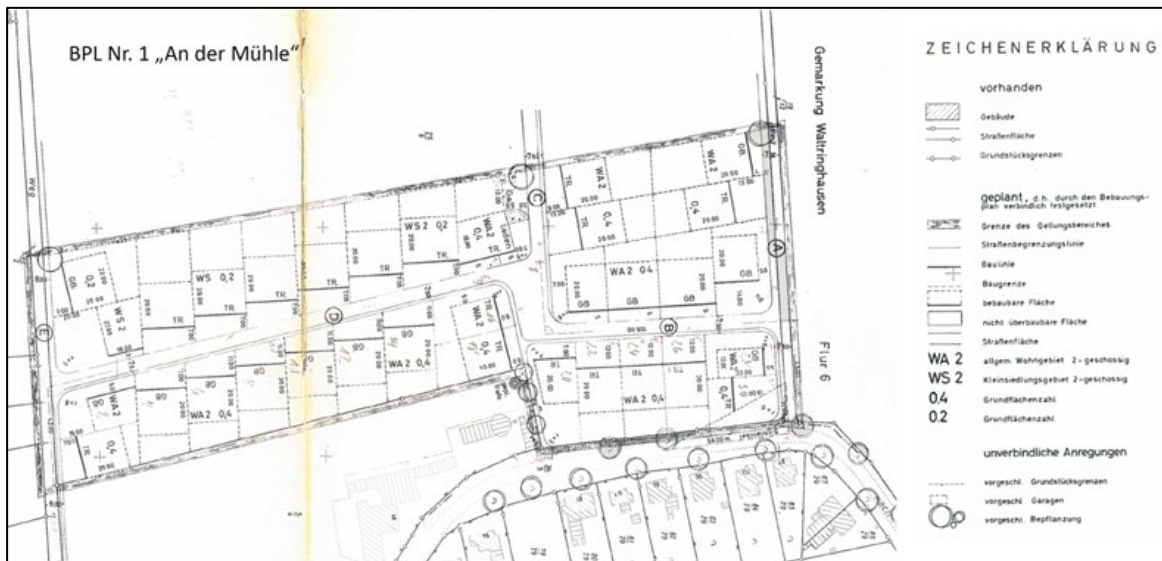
Bebauungsplan Nr. 1 „An der Mühle“ (Planzeichnung, unmaßstäblich verkleinert, nicht genordet)
